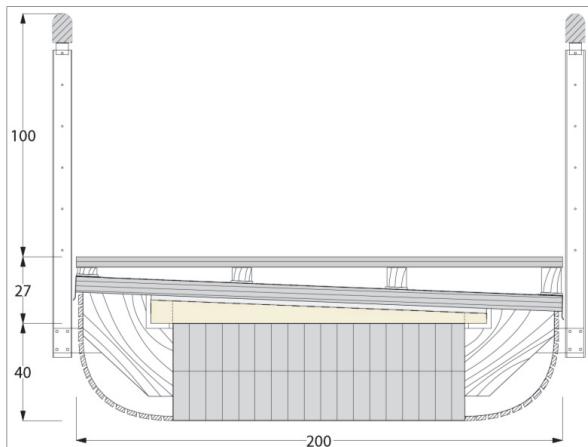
Querschnittsaufbau der Stuttgarter Brücke
